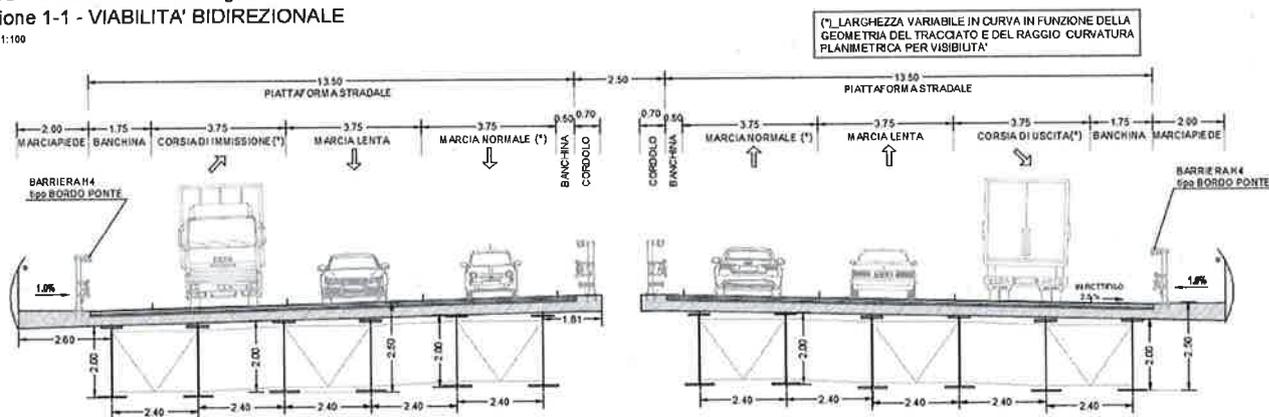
Sezione trasversale Cavalcaferrovia Scaligeri
